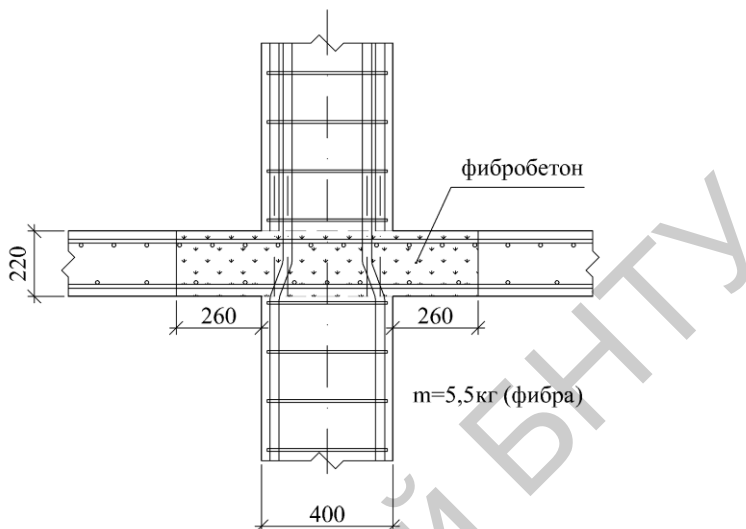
Схема поперечного армирования зоны продавливания плиты стальной фиброй. Класс бетона С20/25, расход стали— 5,5 кг.
